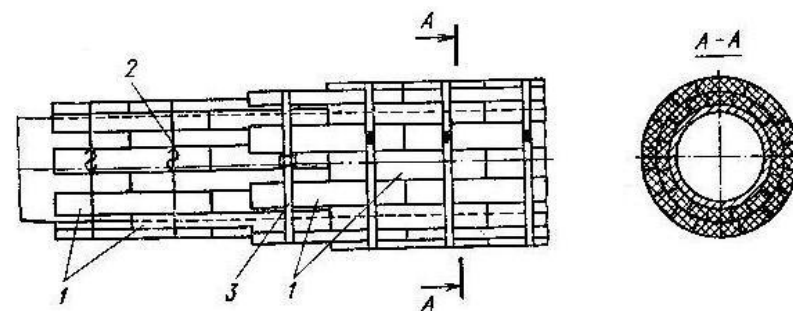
Изоляция трубопроводов жесткими сегментами:
